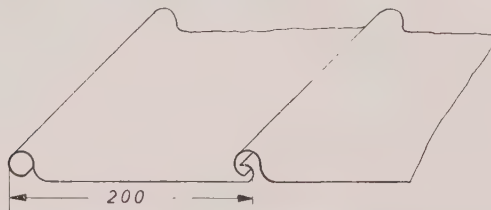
Steildachdeckung mit eingefärbter PVC-Folie auf Dachlatten
